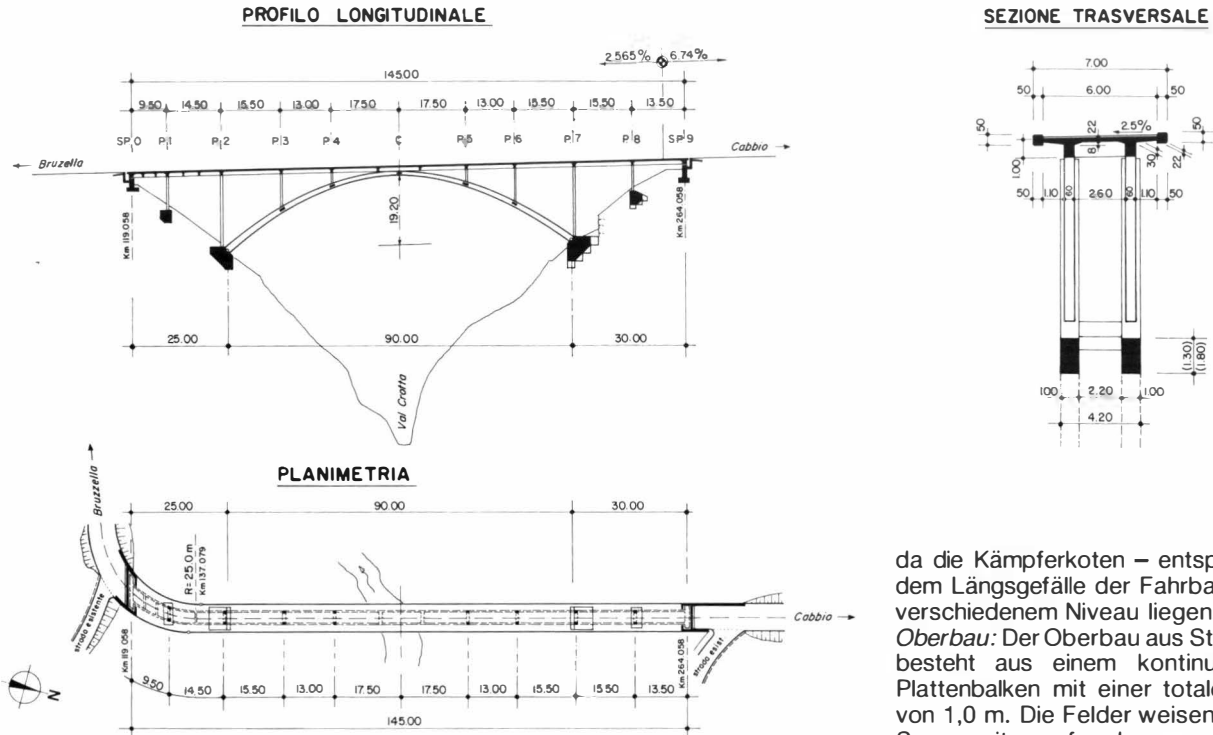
Grundriss, Längs- und Querschnitt – Plan, coupes longitudinale et en travers – Ground plan, longitudinal and cross sections
